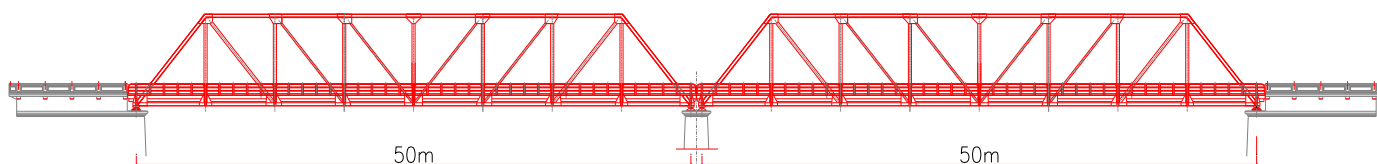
Alçado Longitudinal (Fonte: Estradas de Portugal)
